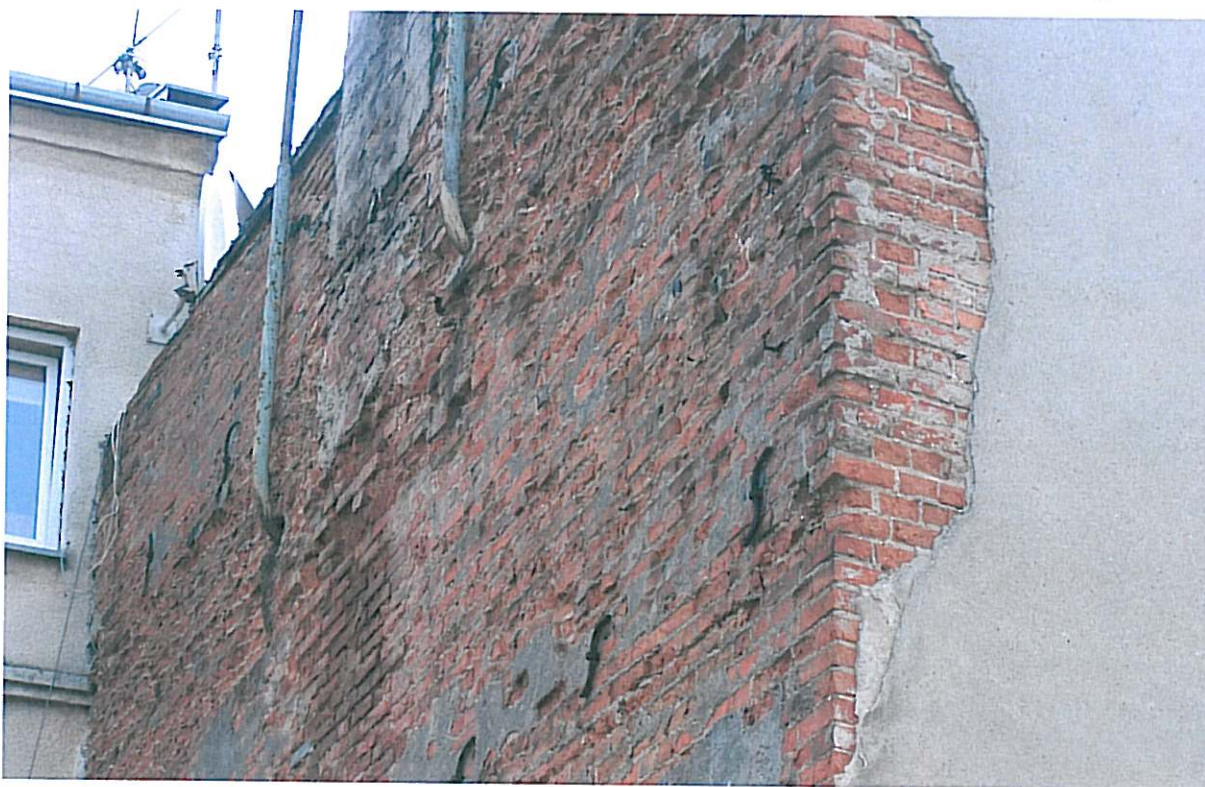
Elewacja wschodnia frontowa rzut przedstawiony w zał. nr 8.
